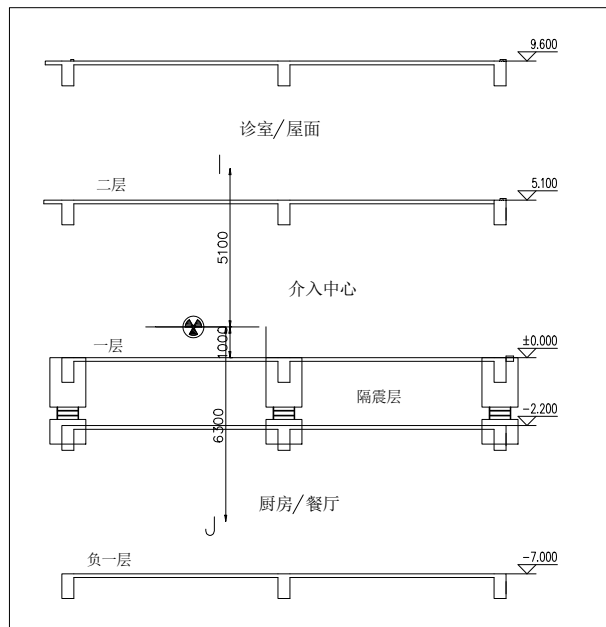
东门诊医技楼一层介入中心 DSA 机房楼上、楼下剖面图
